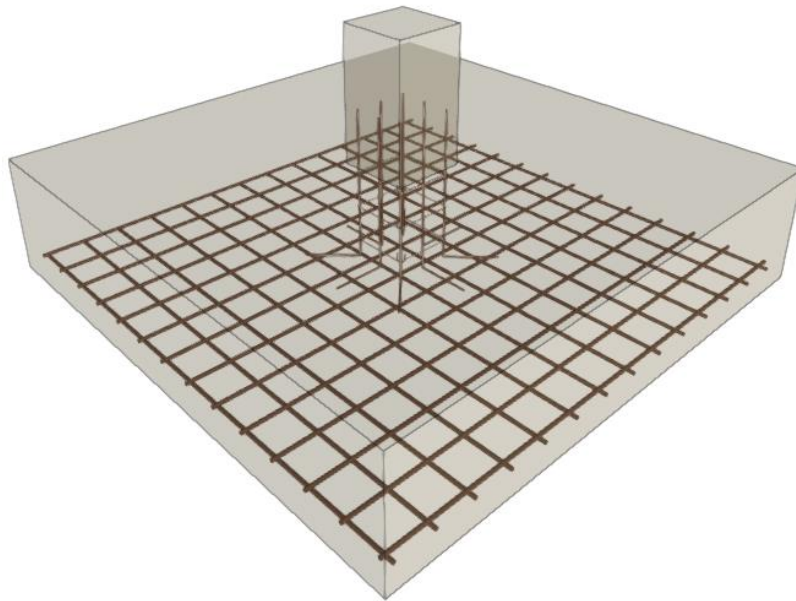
Vista 3D de la zapata aislada bajo pilar P7
